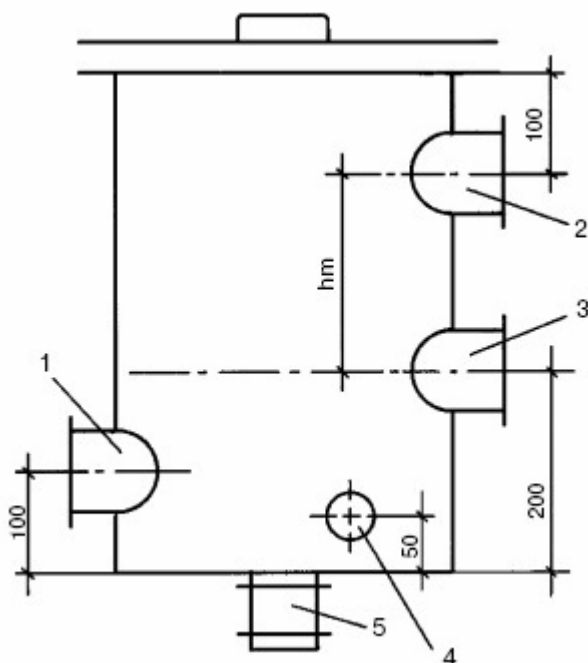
Открытый демпфер: 1 – расширительный патрубок; 2 – переливной патрубок; 3 – контрольная труба; 4 – циркуляционный патрубок; 5 – спускной патрубок с пробкой
